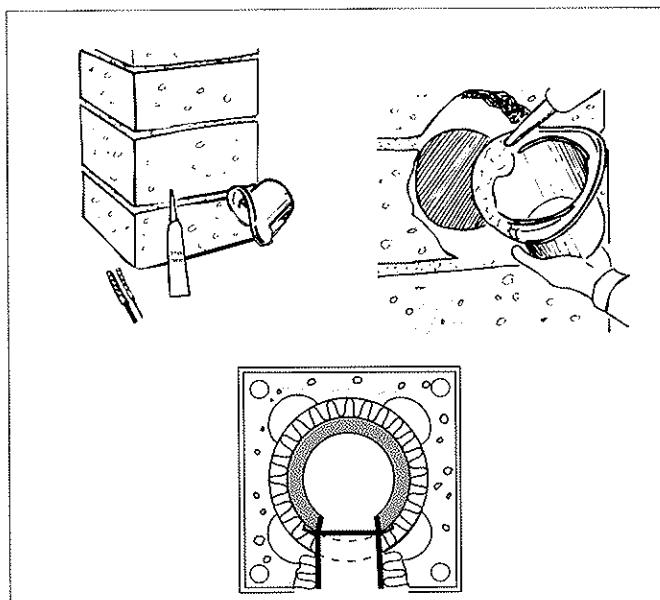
Montering av røykinnføring. Tetting er meget viktig.
